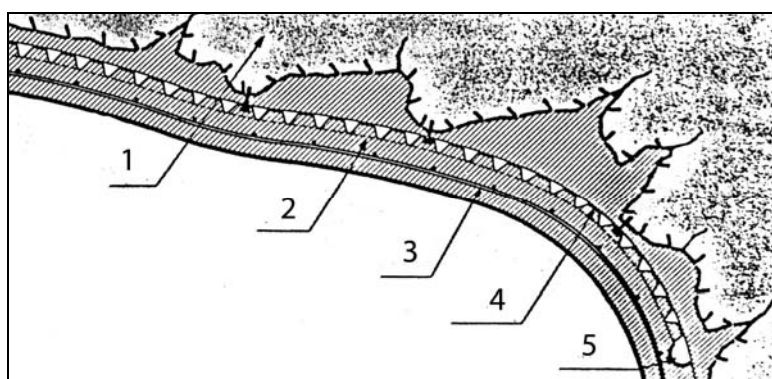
Поперечное сечение торкрет-бетонного покрытия с использованием в качестве водоотвода «дренажной» фольги и желоба. 1 – скала; 2- торкретбетон; 3 – арматурная сетка; 4 – «дренажная» фольга; 5 – желоб.
